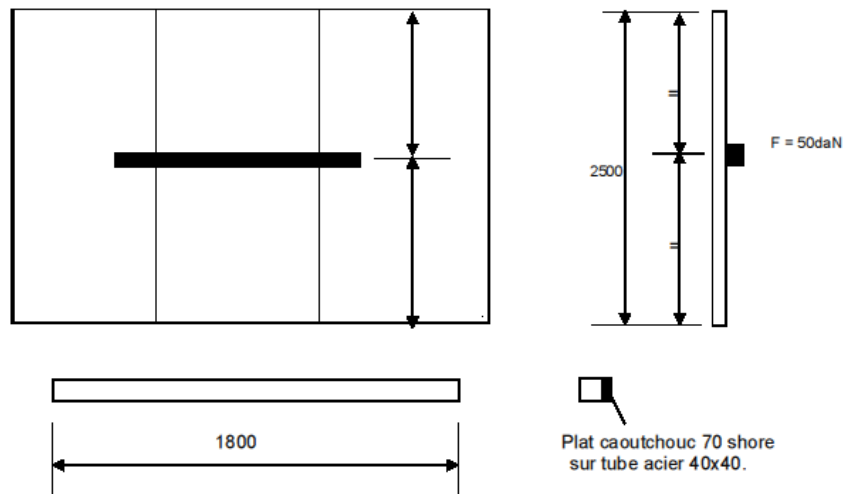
DISPOSITIF DE L'ESSAI DE POUSSEE HORIZONTALE LINEIQUE.
